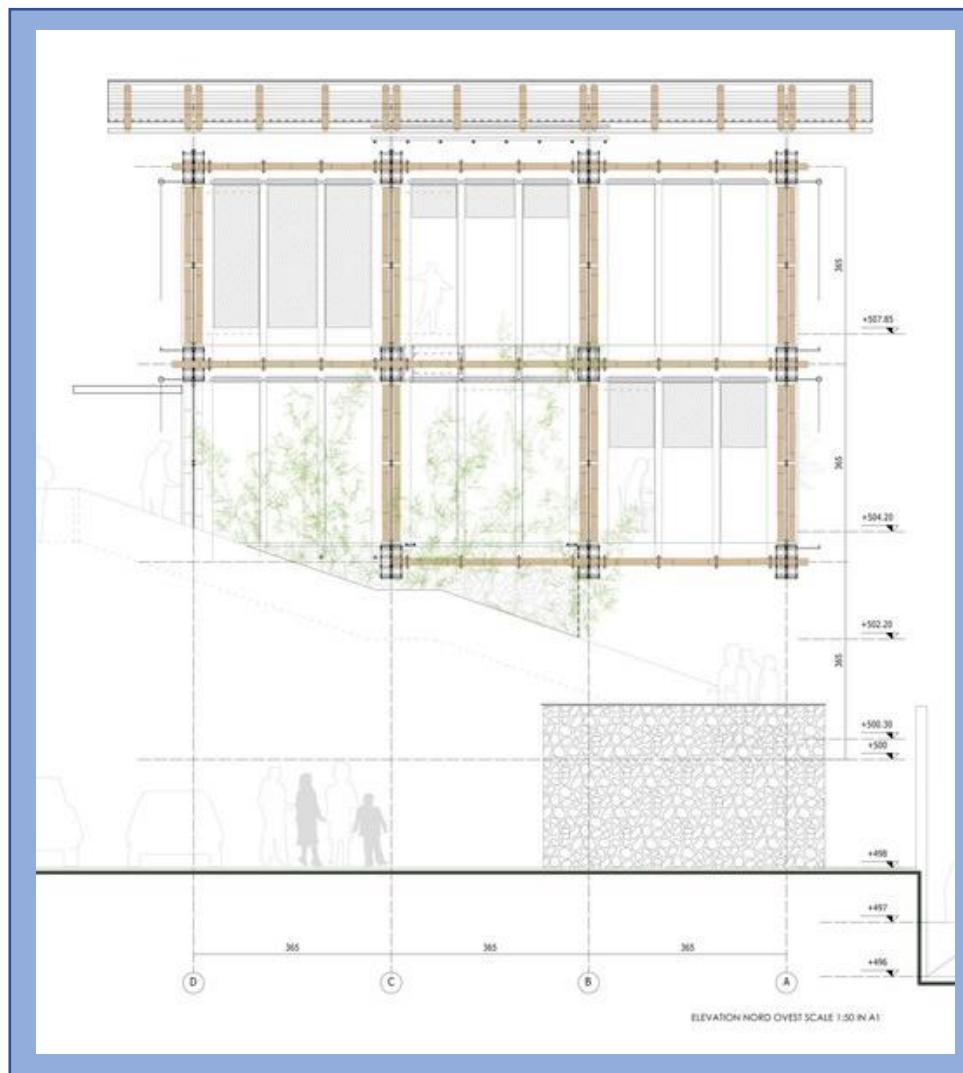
Fuente Plataforma Arquitectura, Detalle de Modulación.
